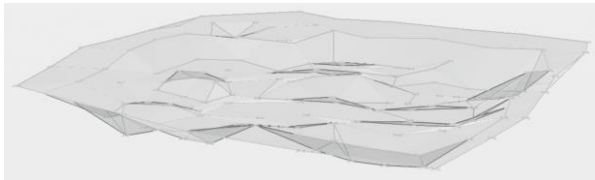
Escaneo láser de fondo de excavación de la misma zapata mostrada en la figura anterior.
